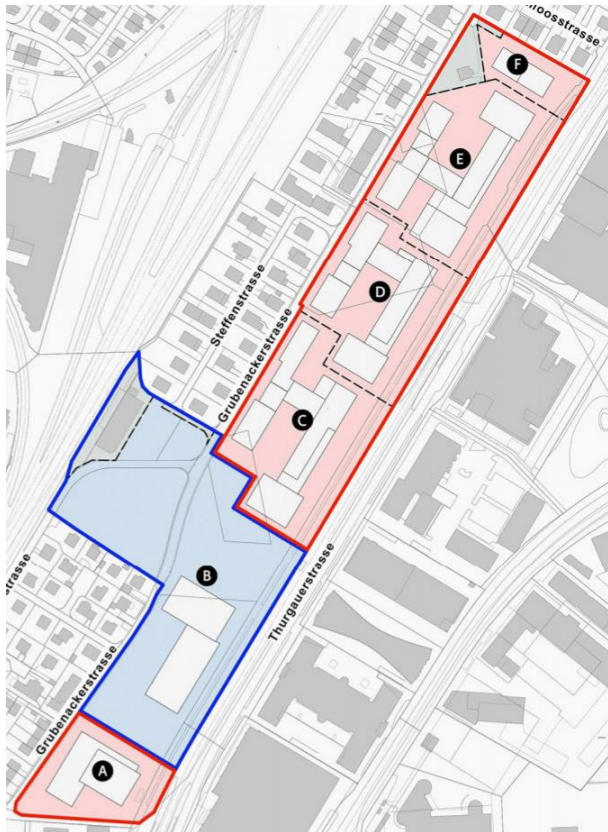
Ansicht des geplanten Projektes Thurgauerstrasse der Stadt Zürich (www.stadt-zuerich.ch/thurgauerstrasse)
